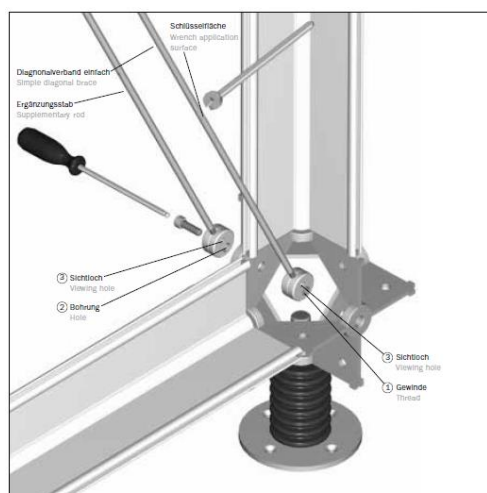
Exemplo ilustrativo da montagem do sistema PILA
